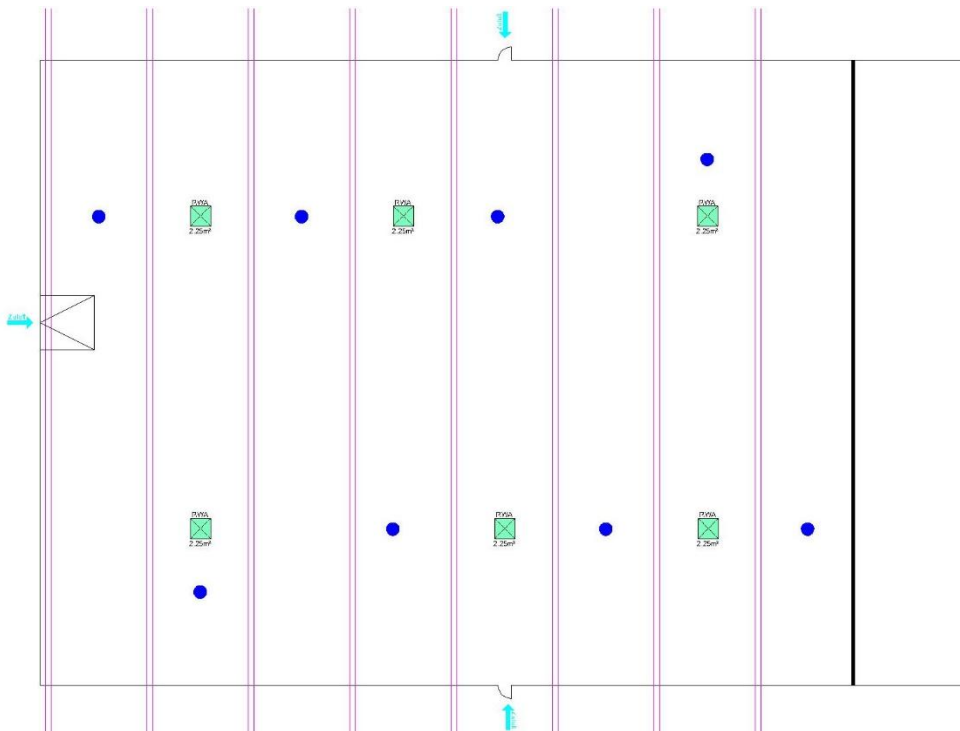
Schematischer Grundriss der Halle mit Einbindung der RWA und Zuluftflächen sowie Sprinklerköpfe (eigene Darstellung)
